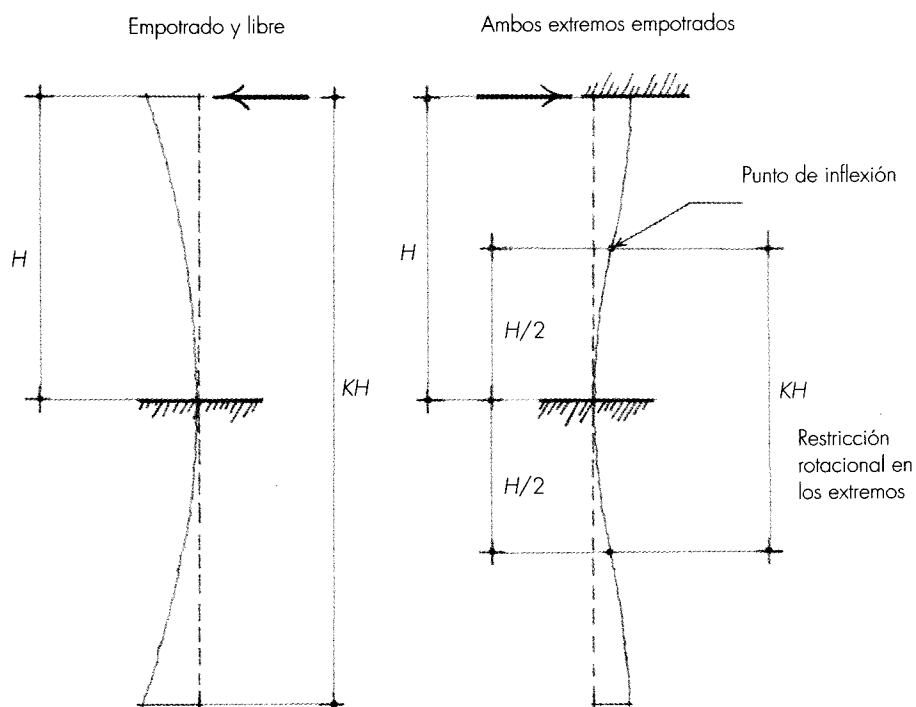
Longitud de pandeo efectiva (H_e). Columnas con desplazamiento lateral no restringido.
